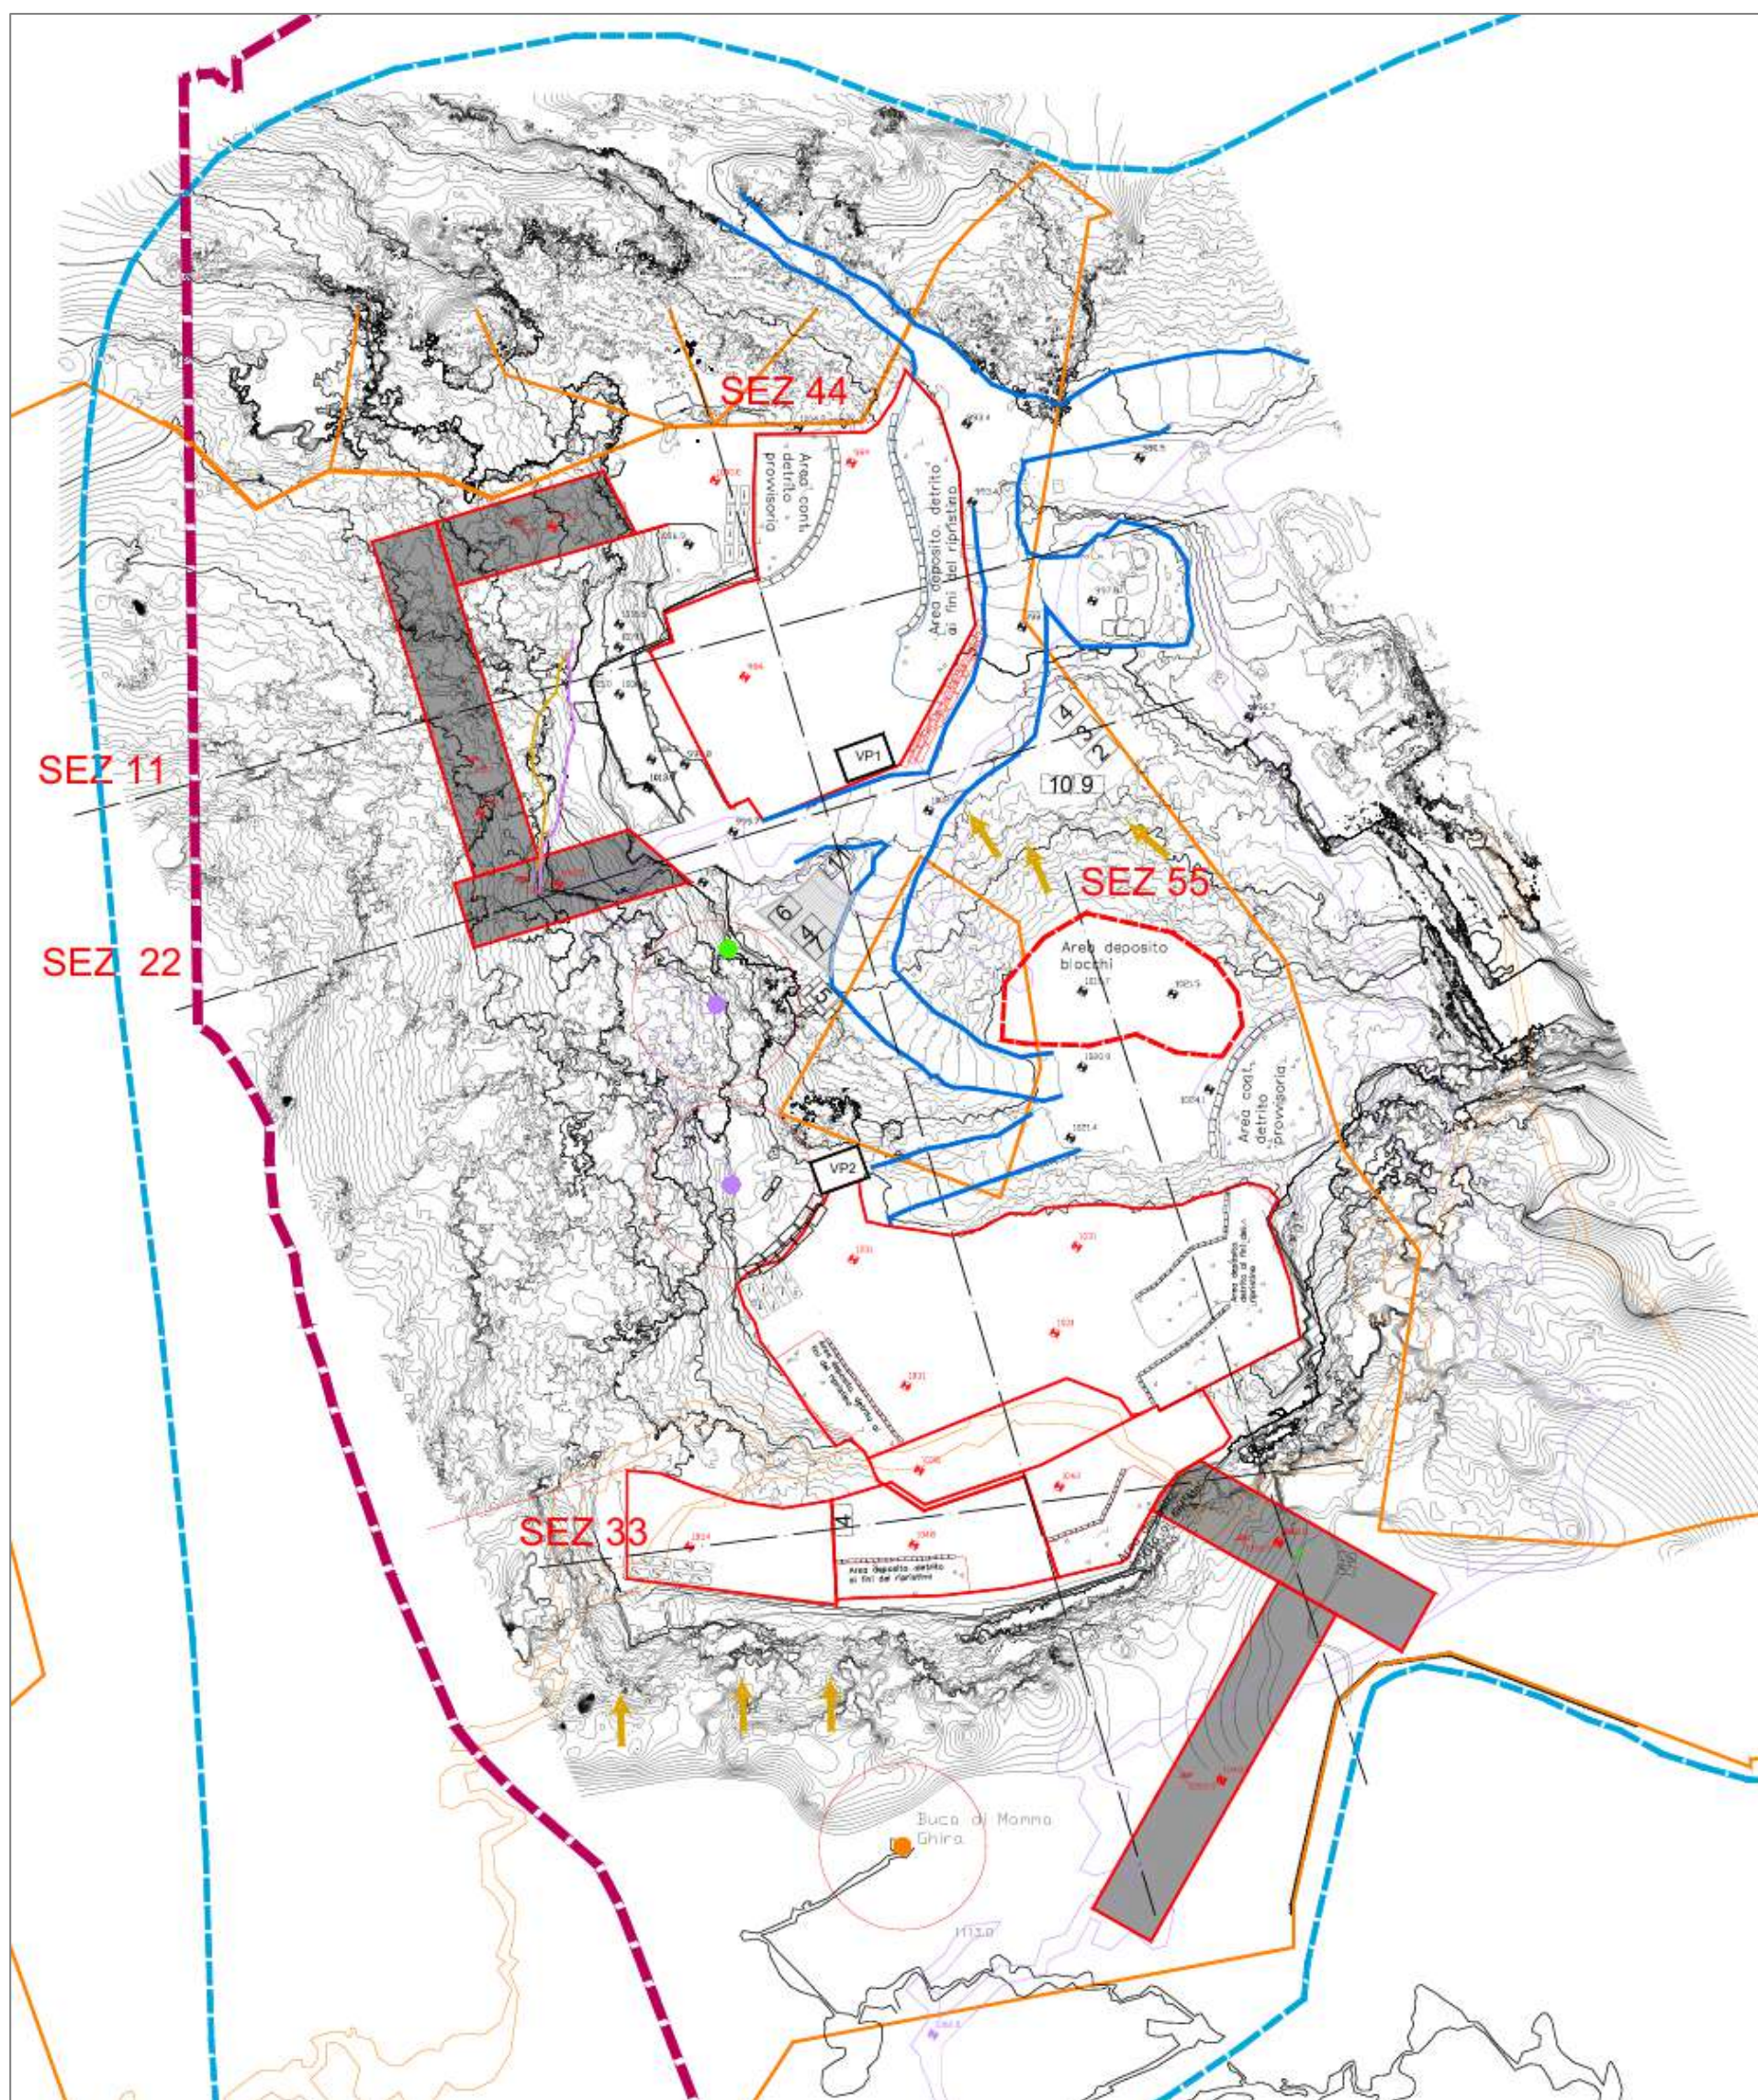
Planimetria FASE 1 (Tav. 9.1).
